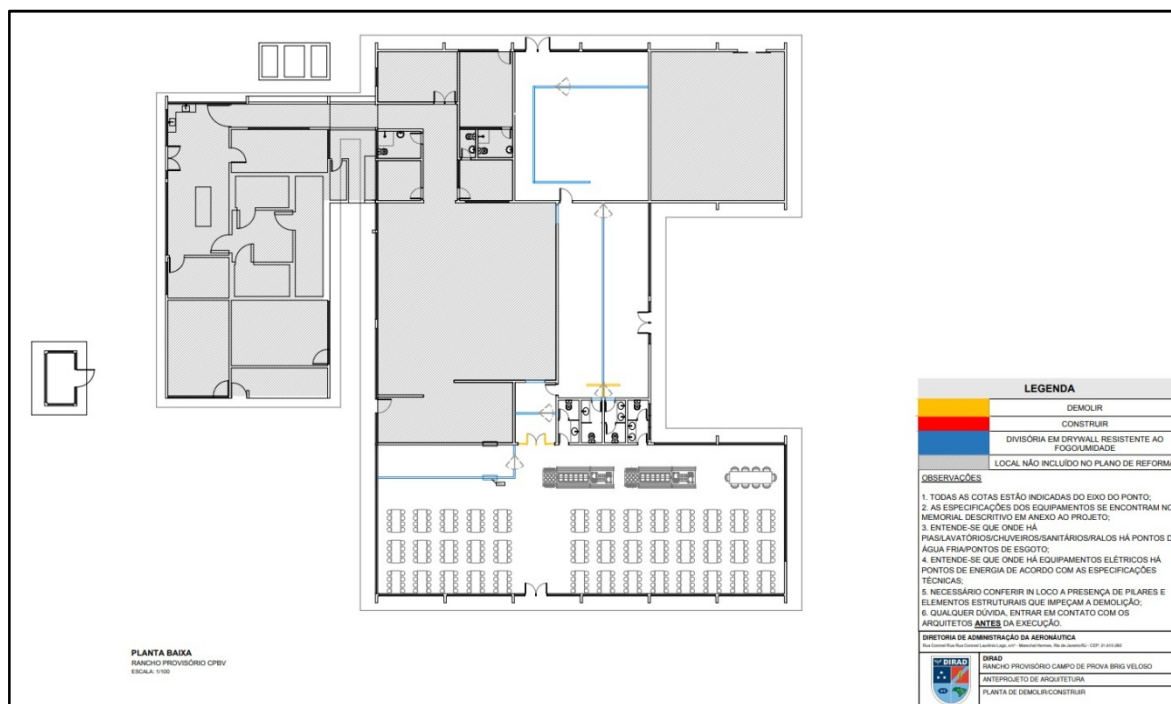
Layout arquitetônico Rancho Provisório CPBV.
